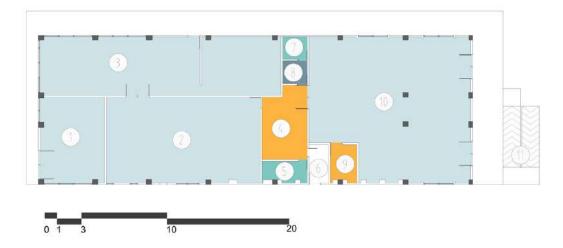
Planta 1 Bloque 51. Fuente: Equipo de diagnóstico.
